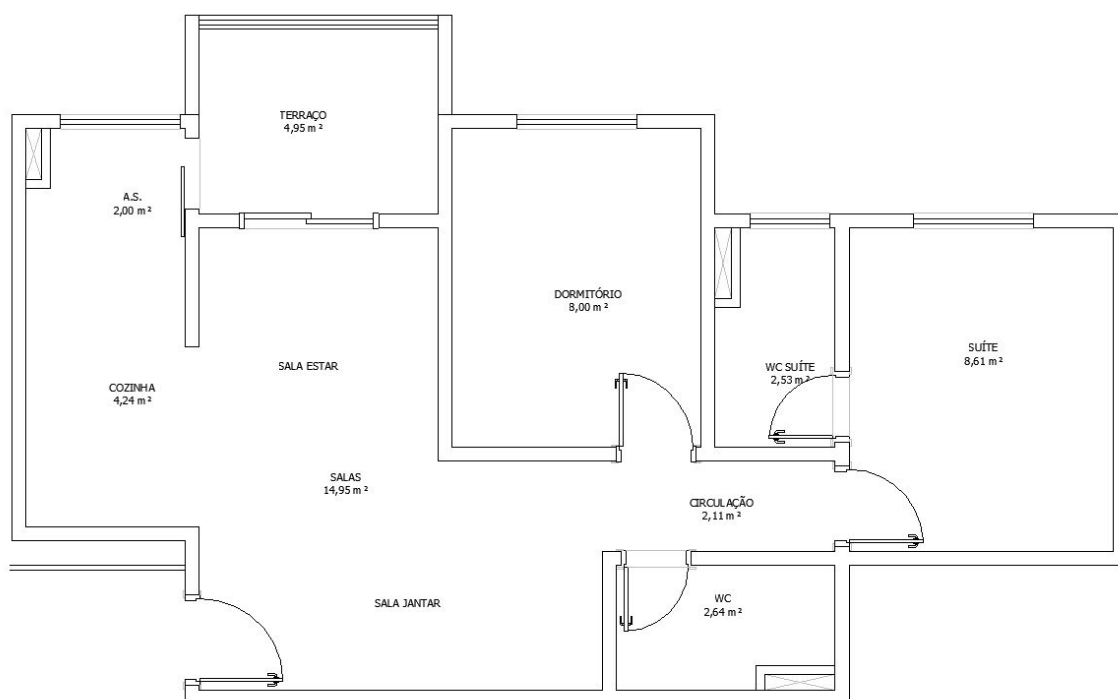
Blocos 1, 3 e 5 – planta apartamento 1 dormitório e 1 suíte.
